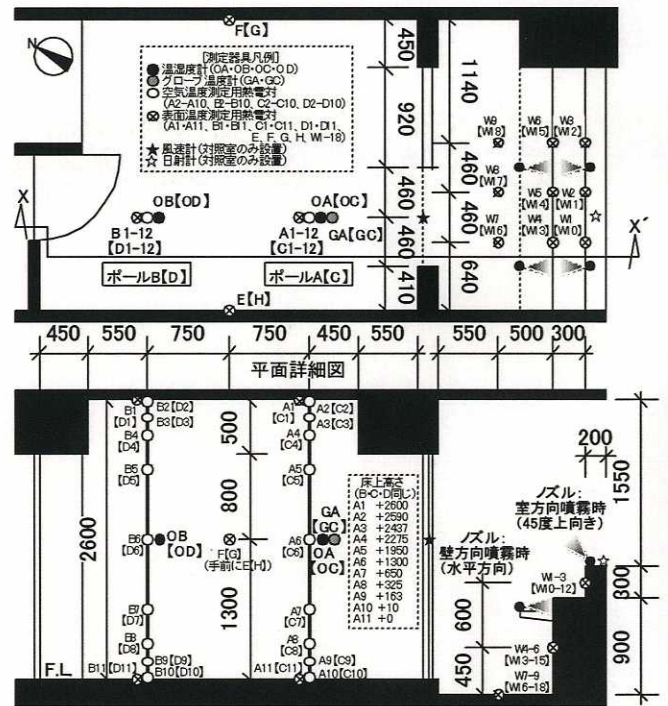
全体平面図・ミスト噴霧室（対照室は上下反転）
